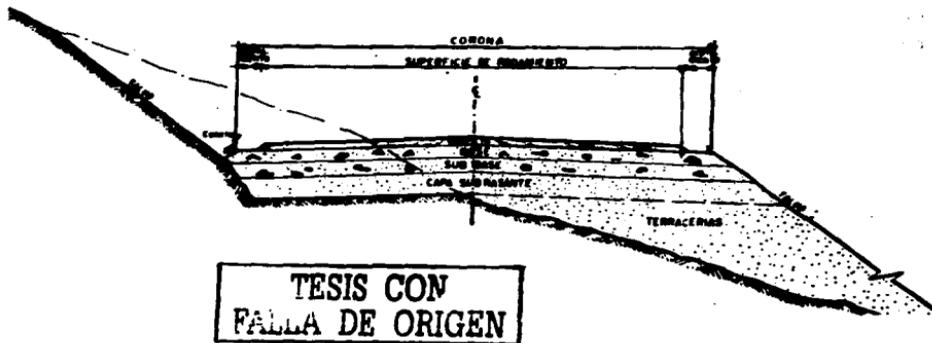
"Sección transversal típica de un pavimento flexible en una sección en balcón"
